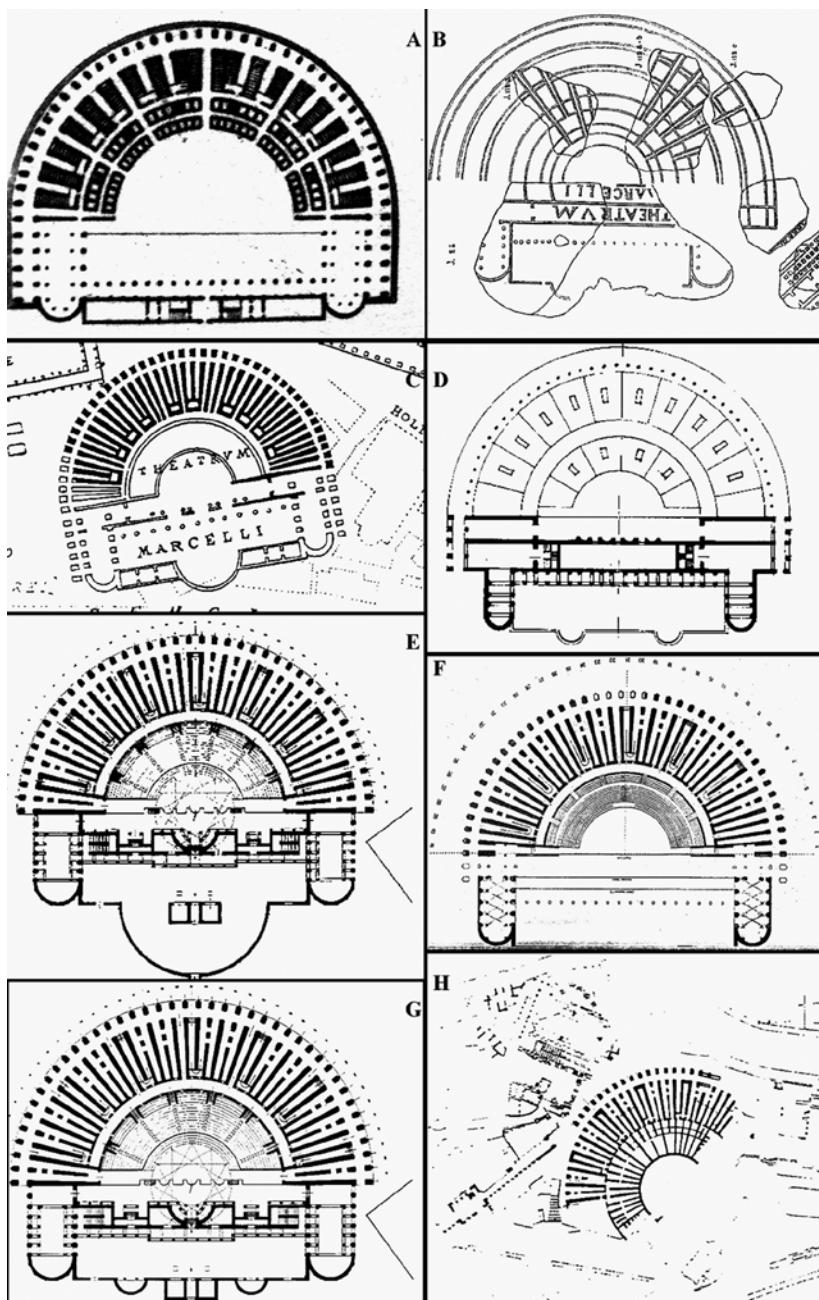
a.- Planta del Teatro de Marcelo de P. Ruga; b.- Planta de E. Jordan y Ch. Hülsen; c.- Planta de E. Kiepter y Ch. Hülsen; d.- Planta de E. Fischer; e.- Planta de P. Fidenzoni; f.- Planta de A. Calza Bini; g.- Planta de P. Fidenzoni; h.- Planta de Sopr. Arch. Comune di Roma.
